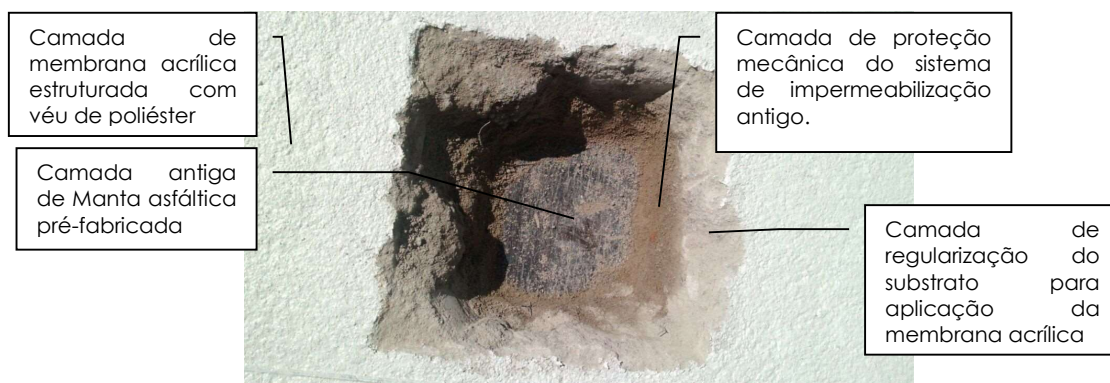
Situação existente na laje de cobertura. (Fonte: a autora, 2017)
